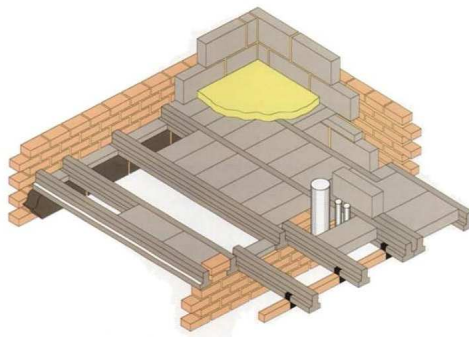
Esquema construtivo de uma laje aligeirada de betão armado (Camposinhos e Neves, 2005).
